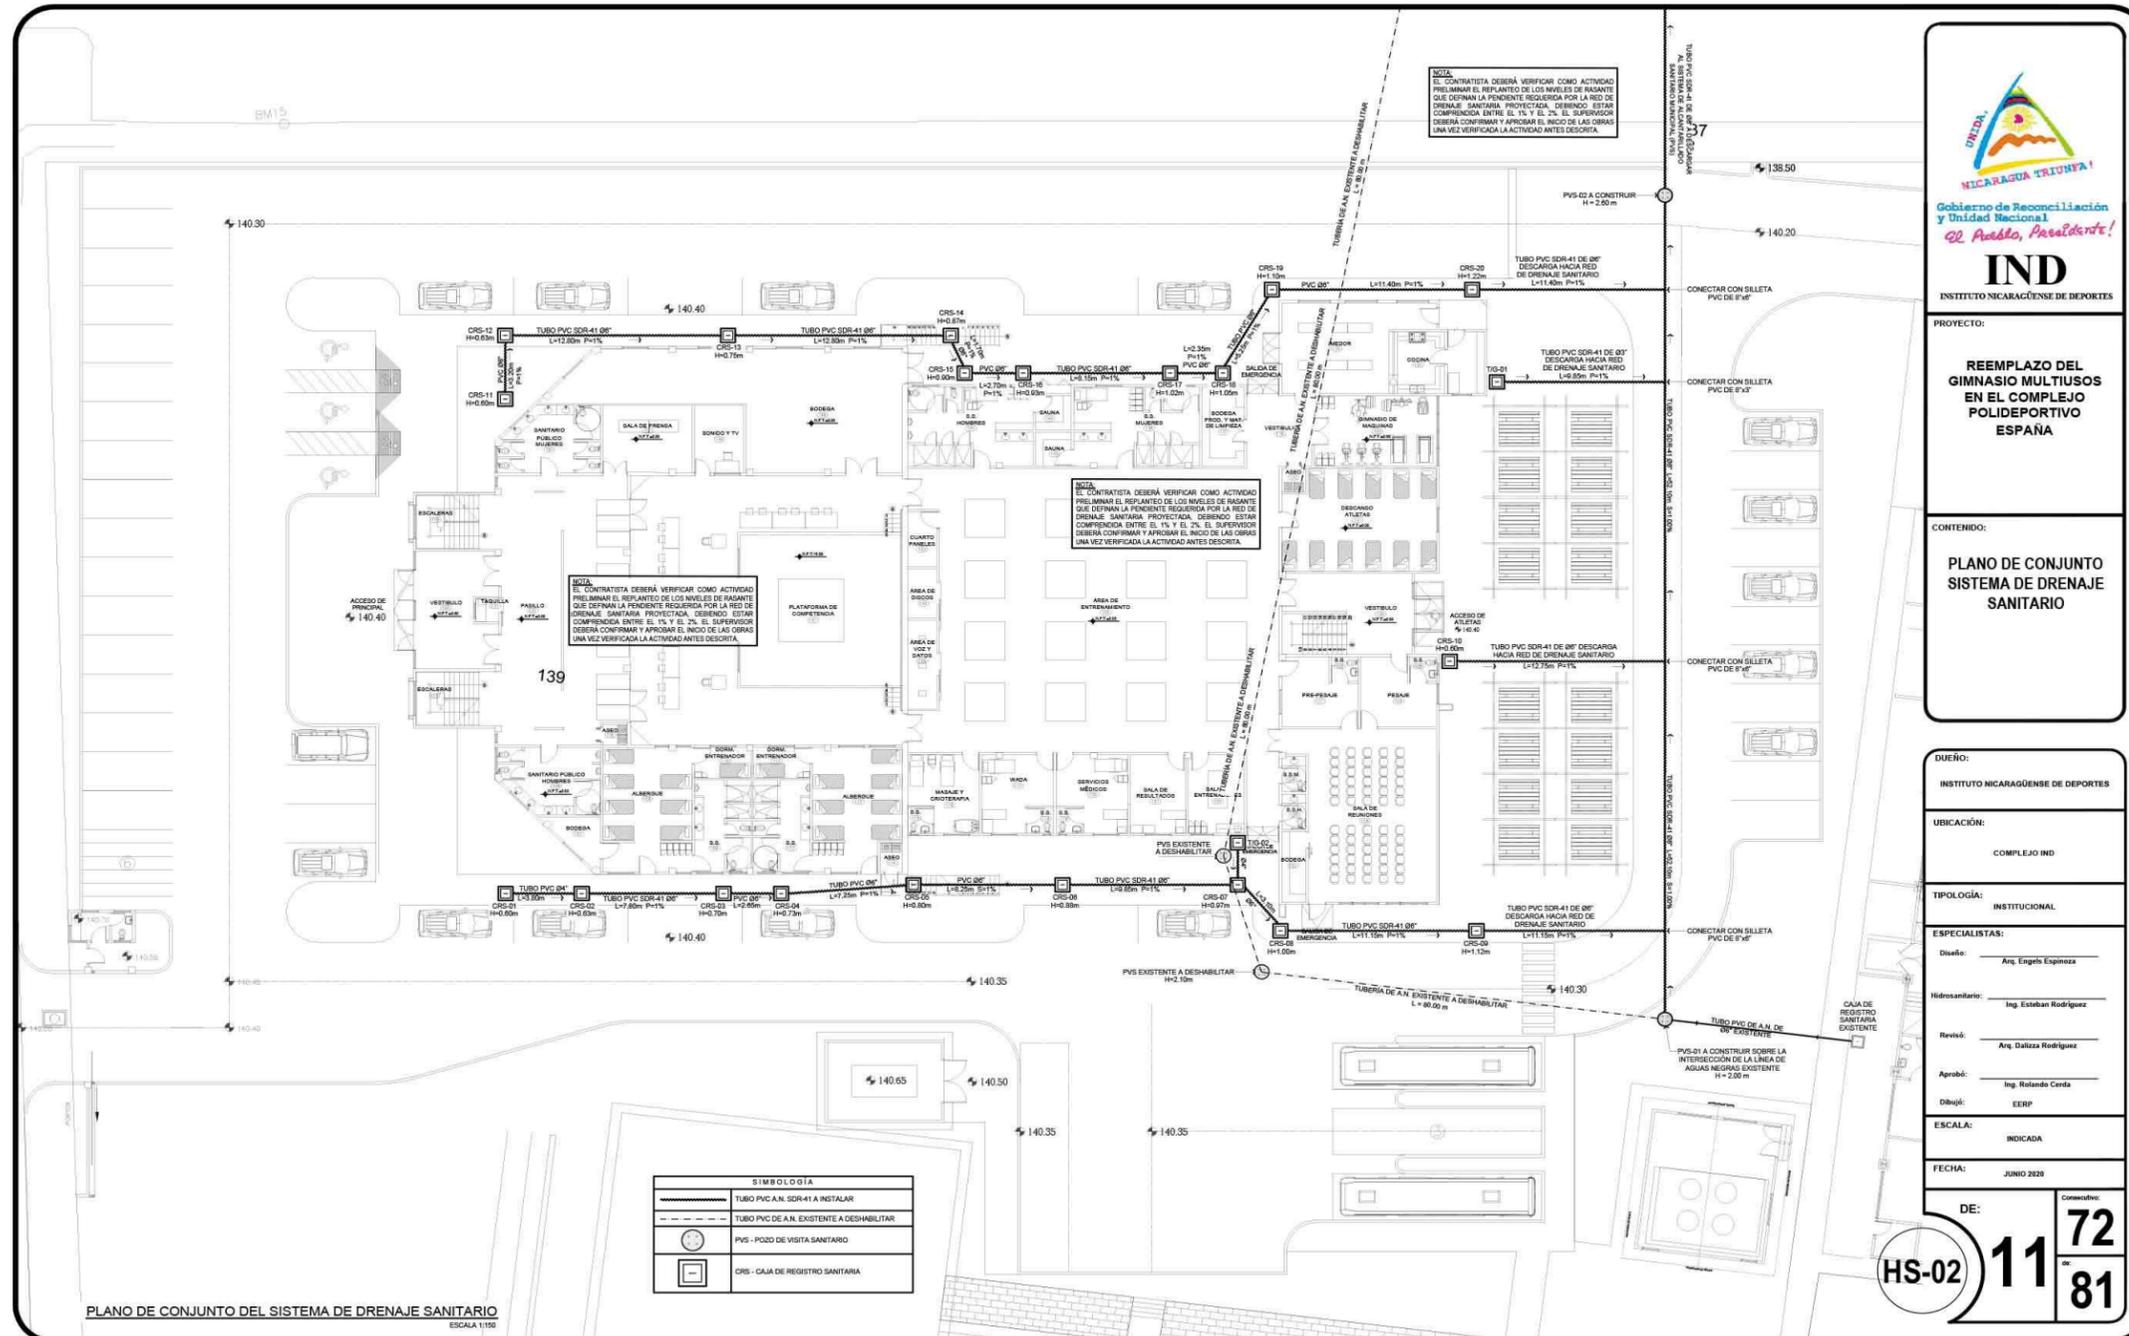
Plano de conjunto del sistema de drenaje sanitario, modificado por la Practicante
